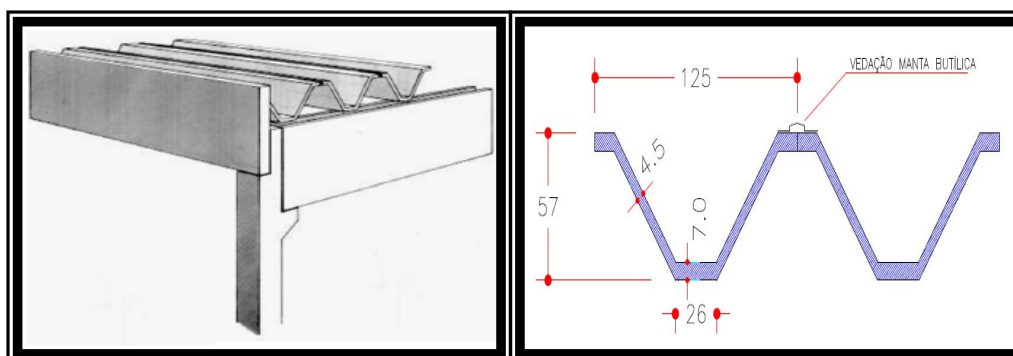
Detalhe em 3D do sistema estrutural da cobertura, com telhas W, vigas calha e pilares pré-fabricados.
